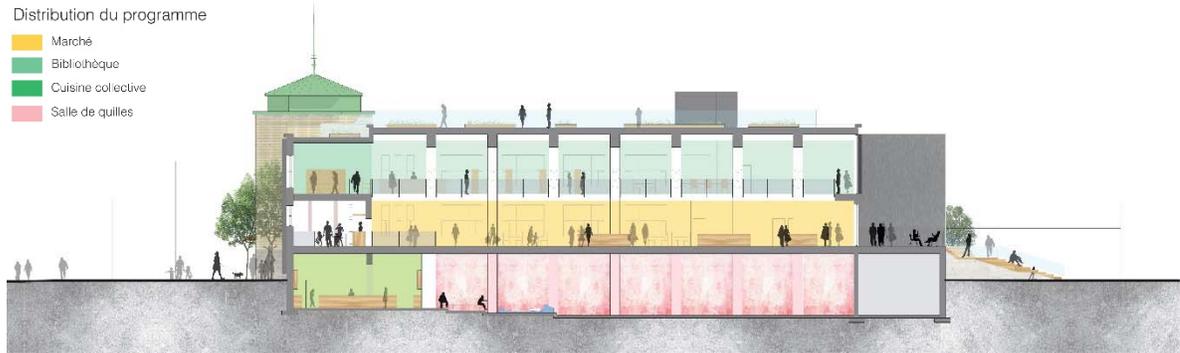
Coupe longitudinale du projet (par l'auteur)
